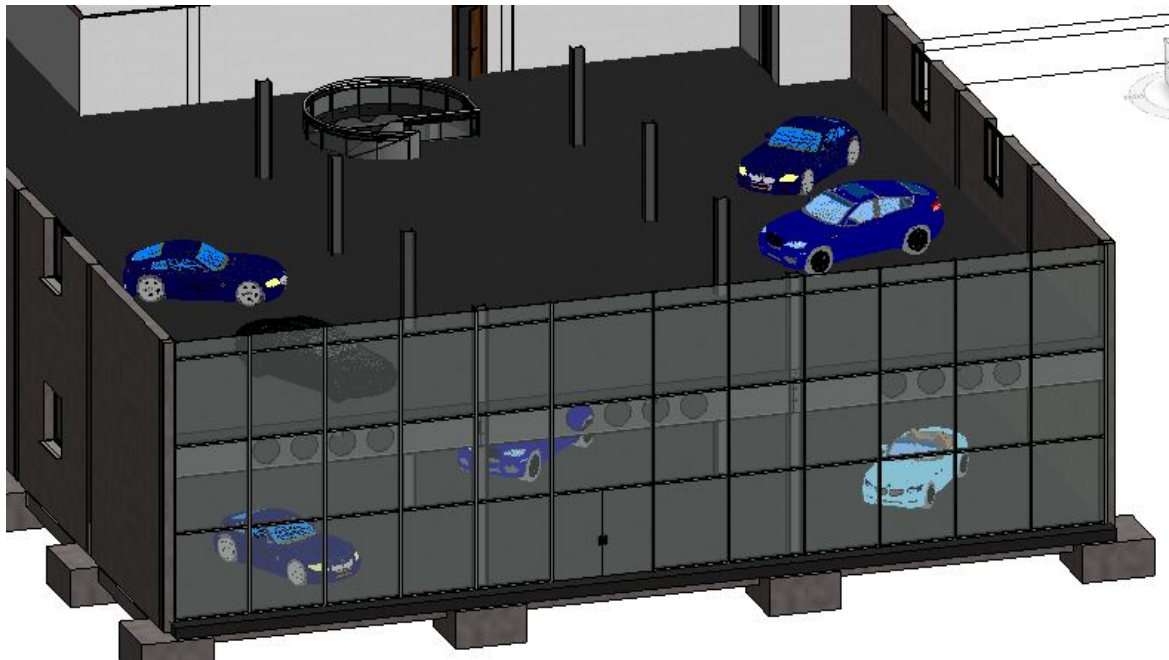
Elementos de detalle en zona de exposición Planta Alta
